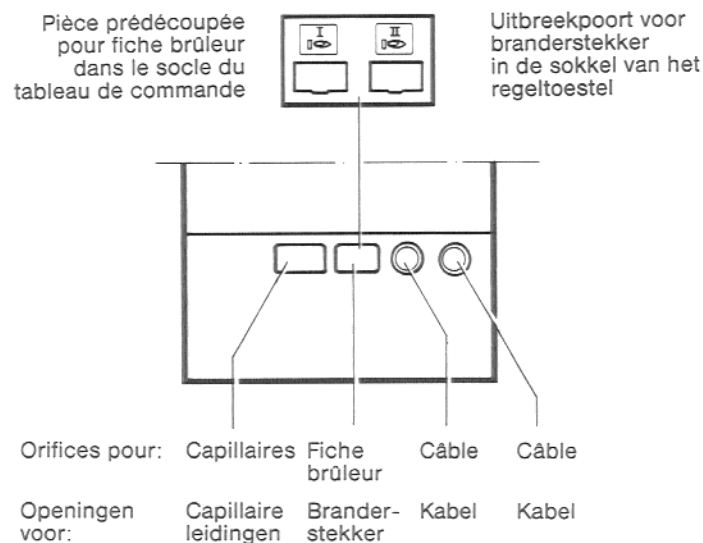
Un bloc chaudière G\_324 D, vue arrière
